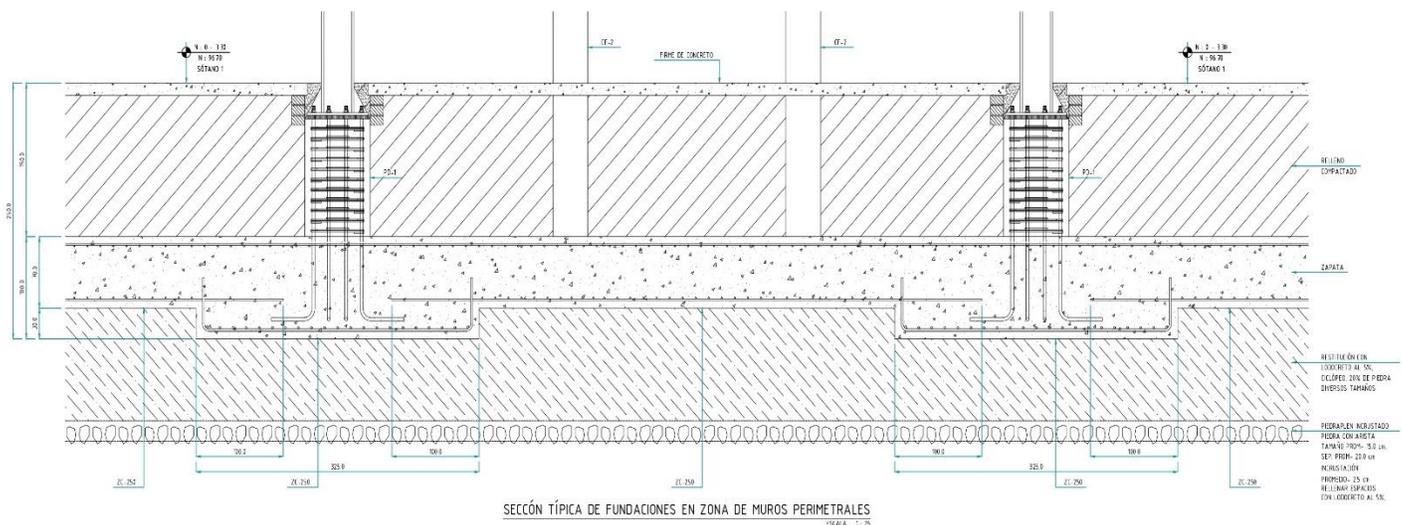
DONDE SE OBSERVA LA ZAPATA CORRIDA 250 PROPUESTAS EN EL PROYECTO.
